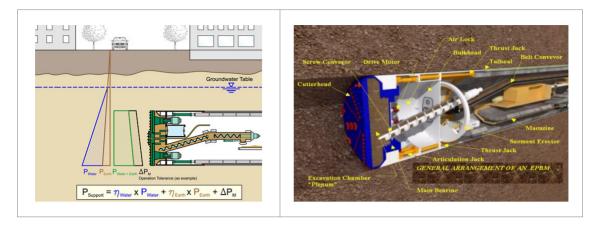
Schémas d'un tunnelier de type EPBM
